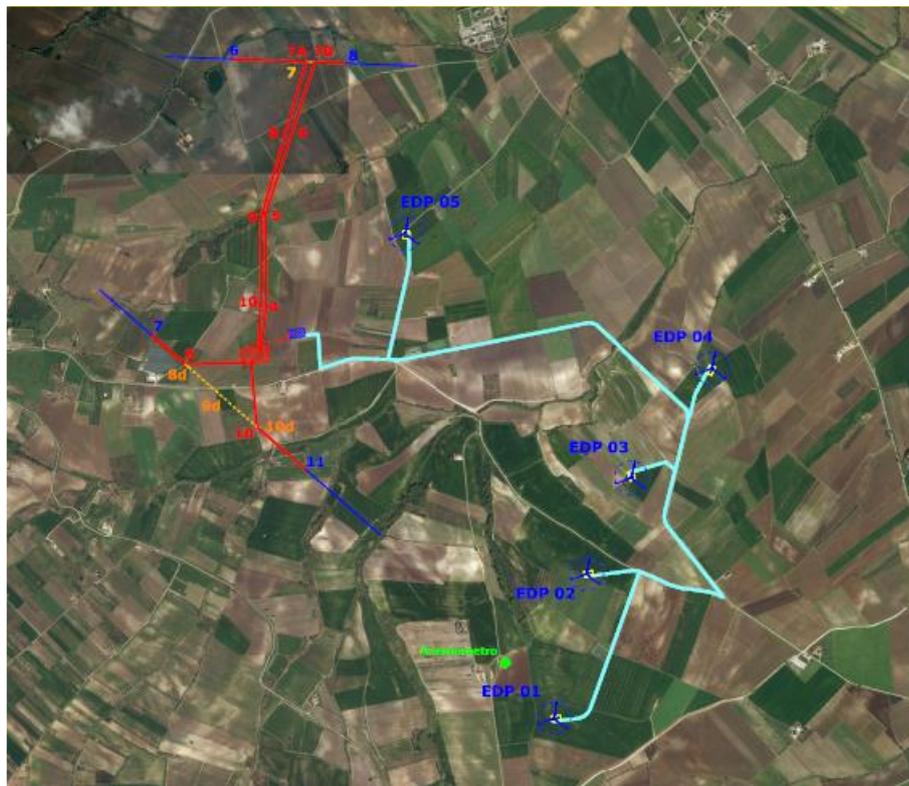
Stralcio planimetrico – ortofoto -layout impianto
